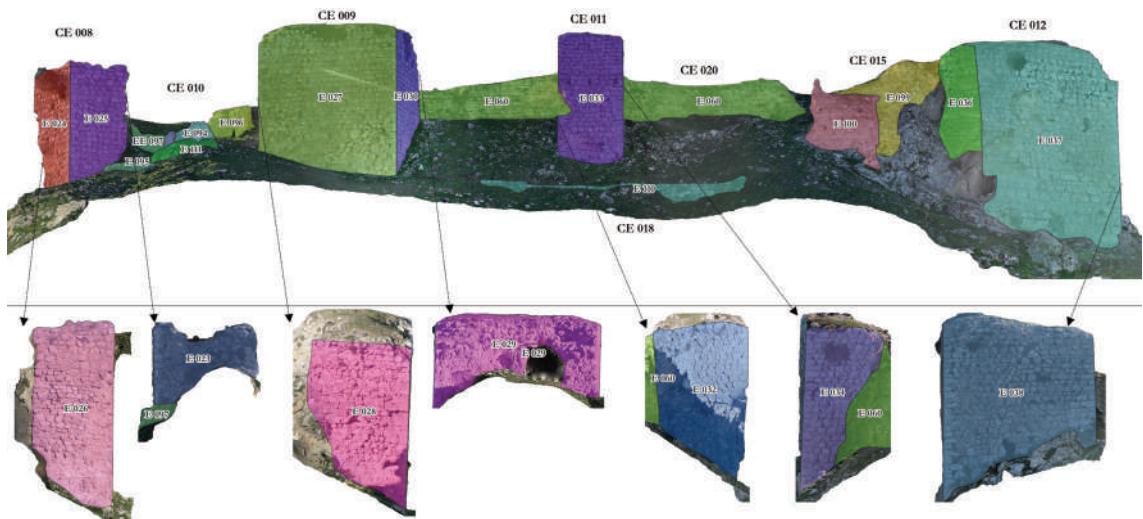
Alzado norte del recinto exterior del castillo de Arenas. Fuente: los autores.
